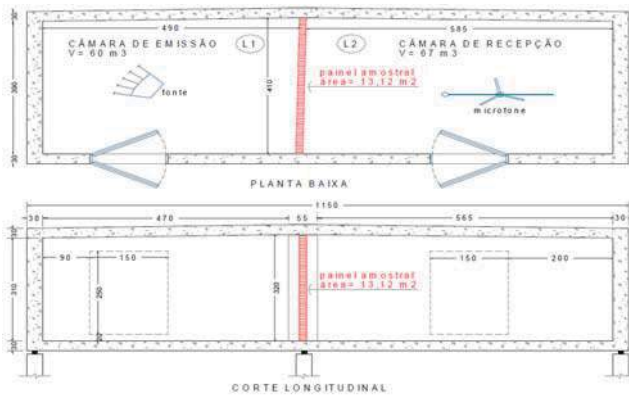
Planta baixa e corte longitudinal das câmaras reverberantes da UFSM (Santos, 2006).
